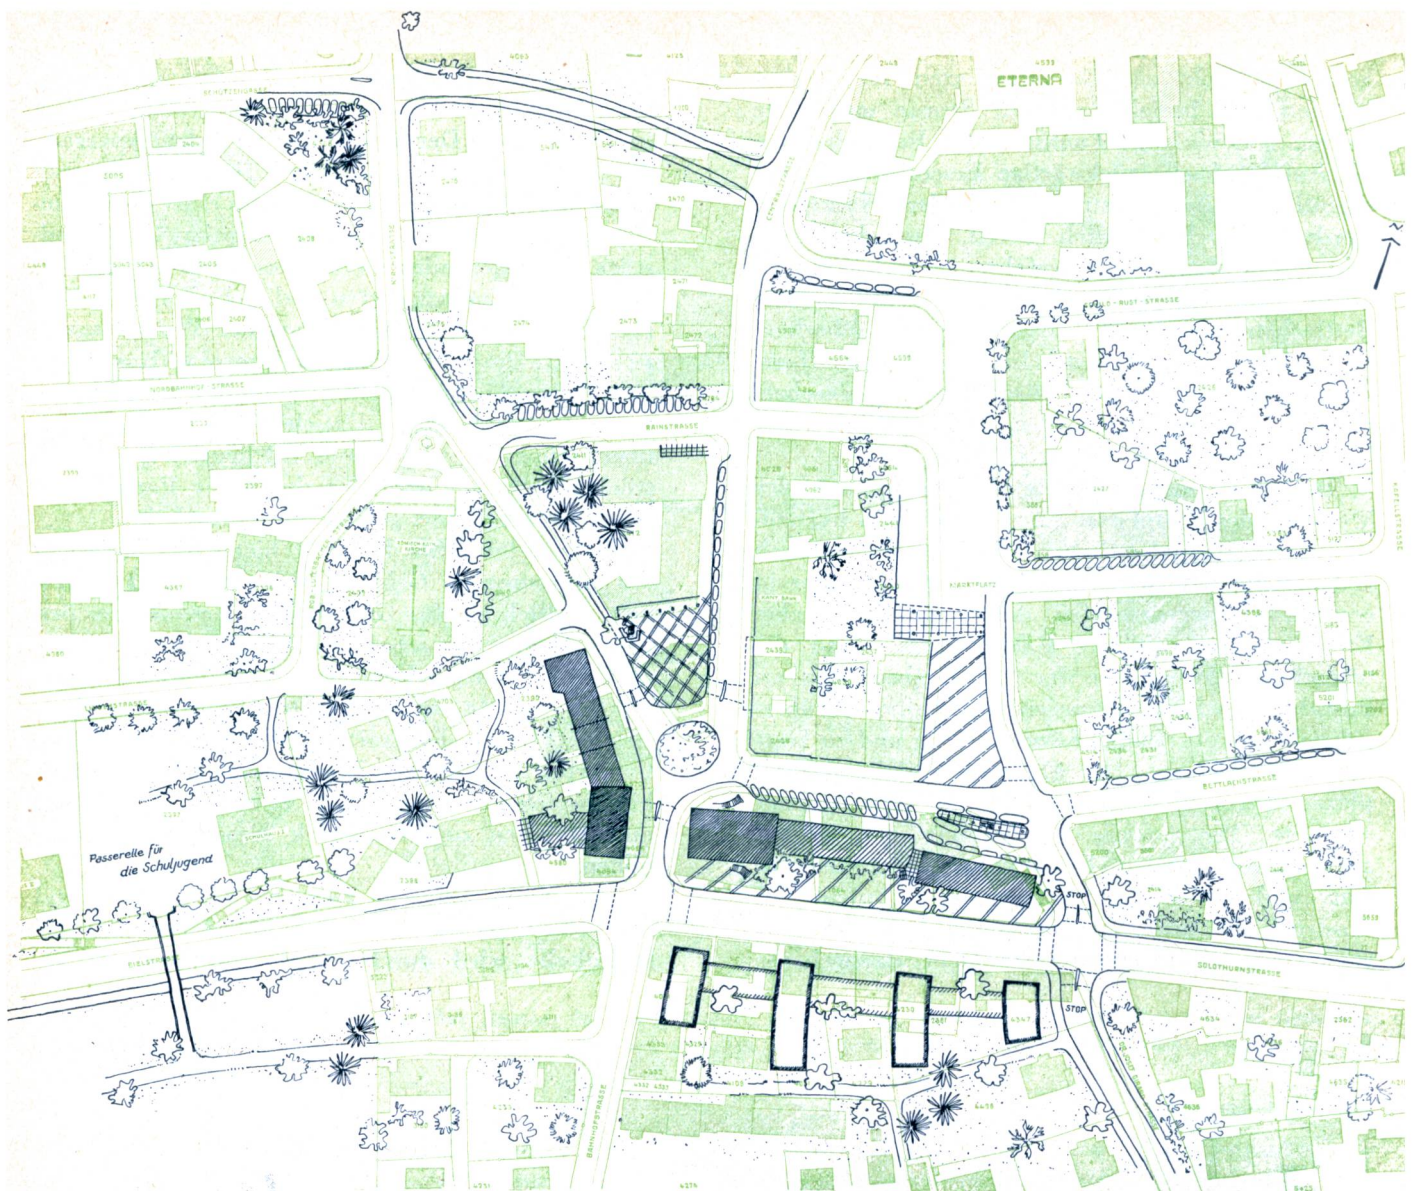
Situationsplan zum Umgestaltungsvorschlag. Einzeilige Bebauung zwischen Solothurn- und Bettlachstrasse. Abtrag der heutigen Post. Erneuerung der westlichen Randbauten des erweiterten Postplatzes. Spätere Rück- und Querstellung der südlichen Bebauung an der Solothurnstrasse. Uebersichtlichere Verkehrslenkung, Parkierung im rückwärtigen Strassensystem.
